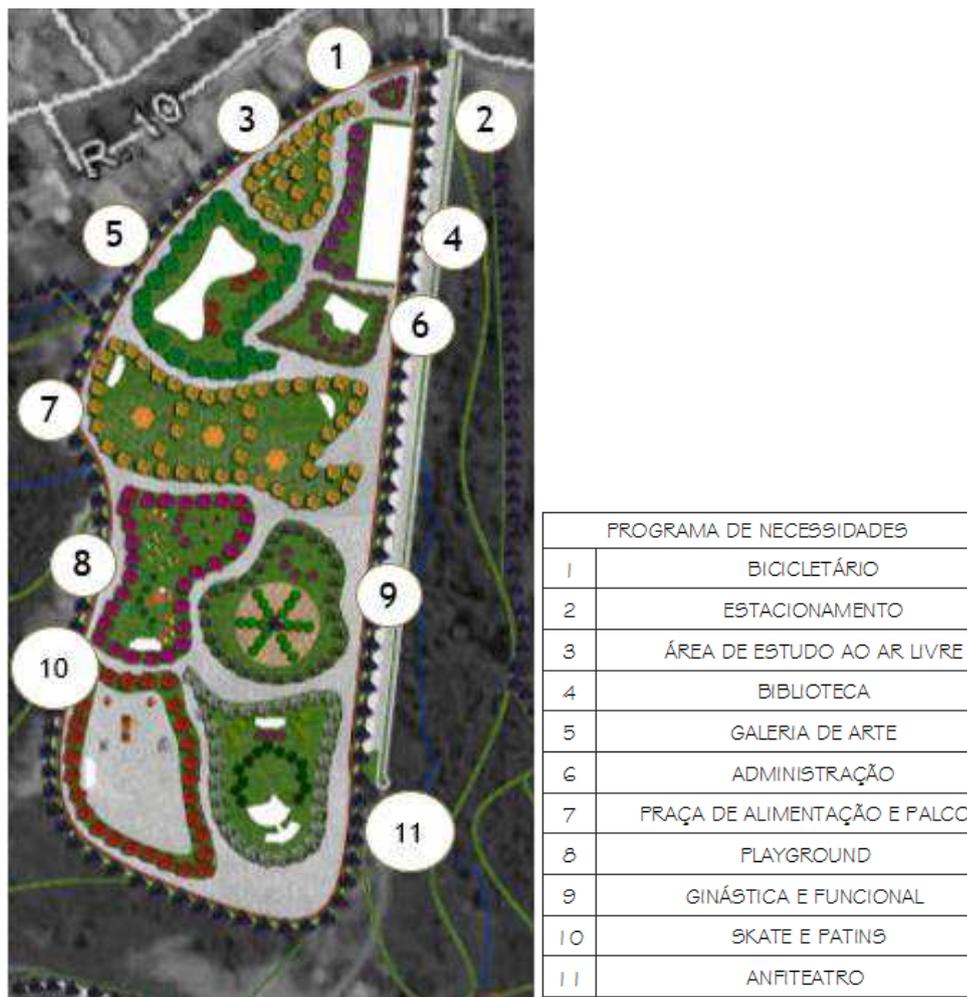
Planta baixa – Setor de Cultura e Lazer.
